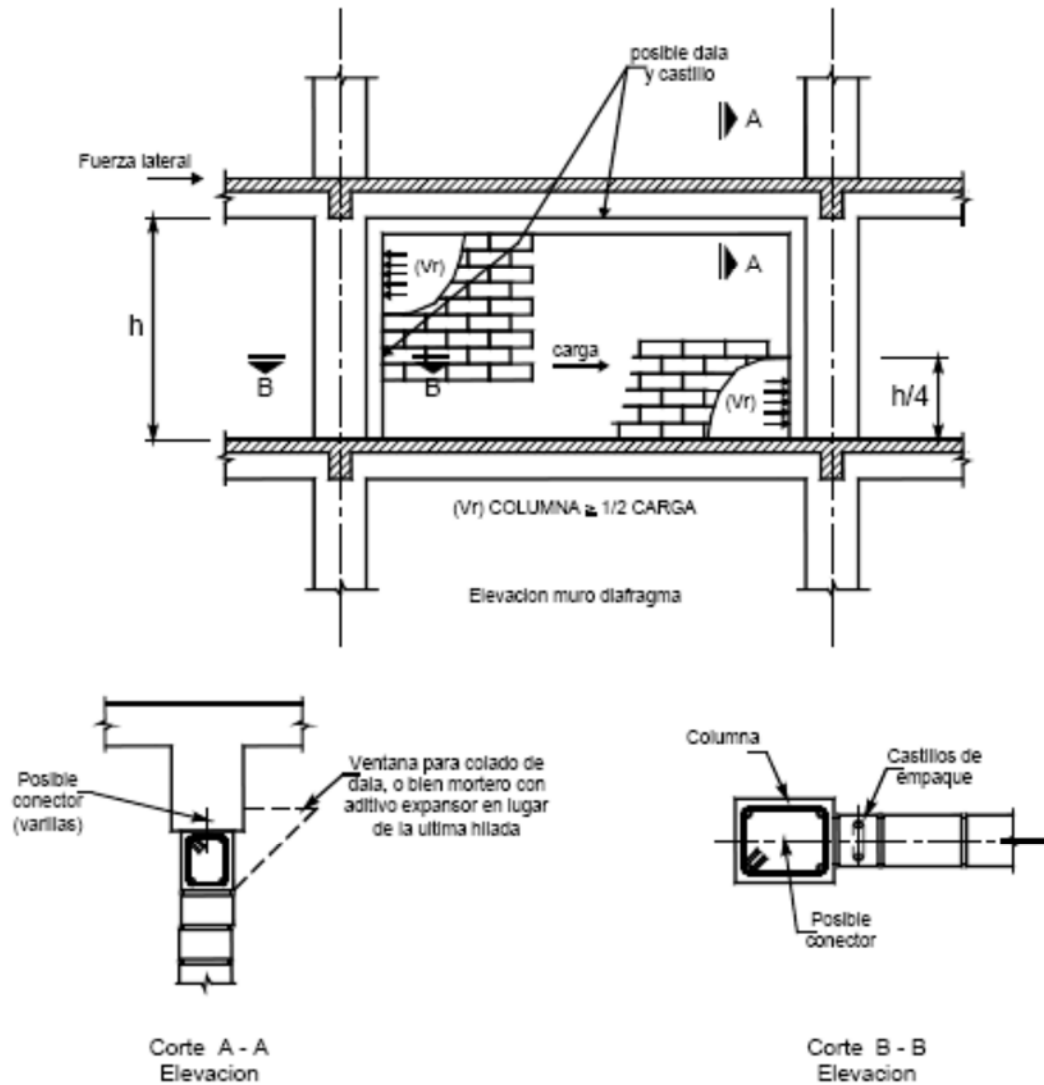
Detalles en planta y elevación de un muro diafragma.
